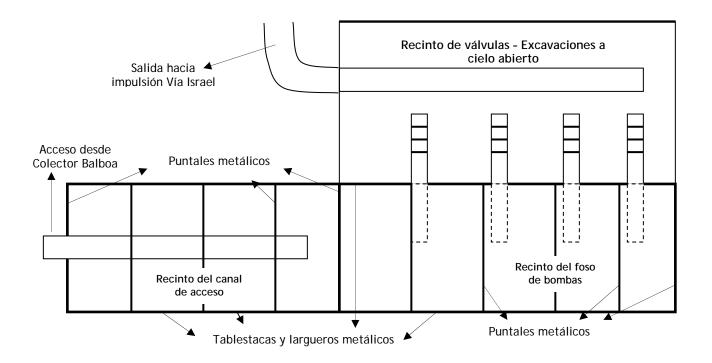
Vista en Planta de las Zonas que deben ser Excavadas y sus Apuntalamientos - Estación de Bombeo Paitilla
